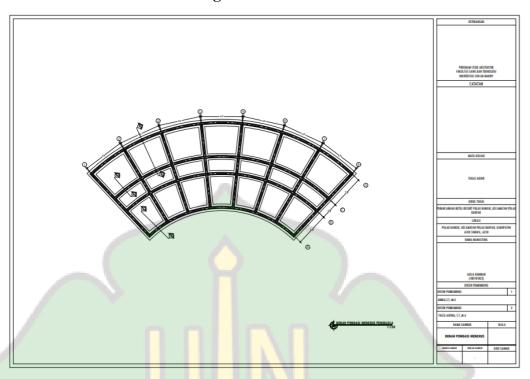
Denah Kolom Backpacker GYM dan SPA
